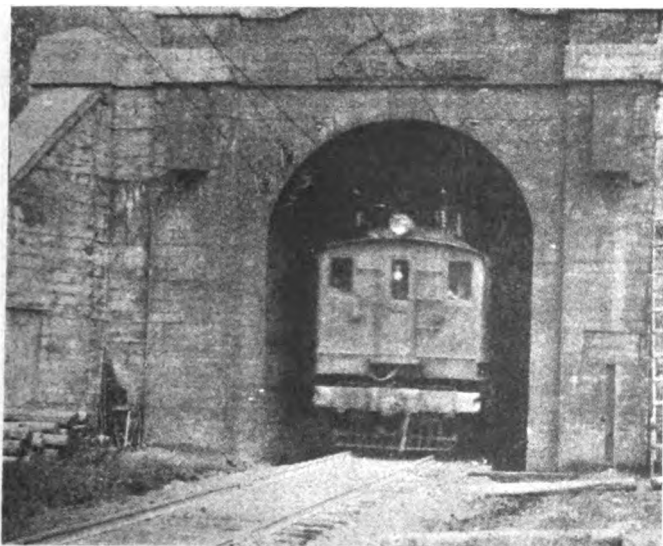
Il Cascade Tunnel della Great Northern Railway.
